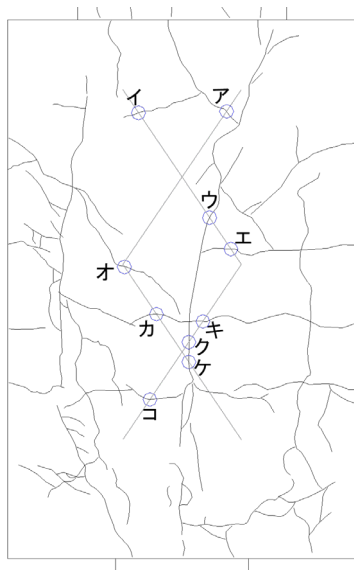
パイルキャップひび割れ幅測定位置 (試験体 B-1 正載荷)
